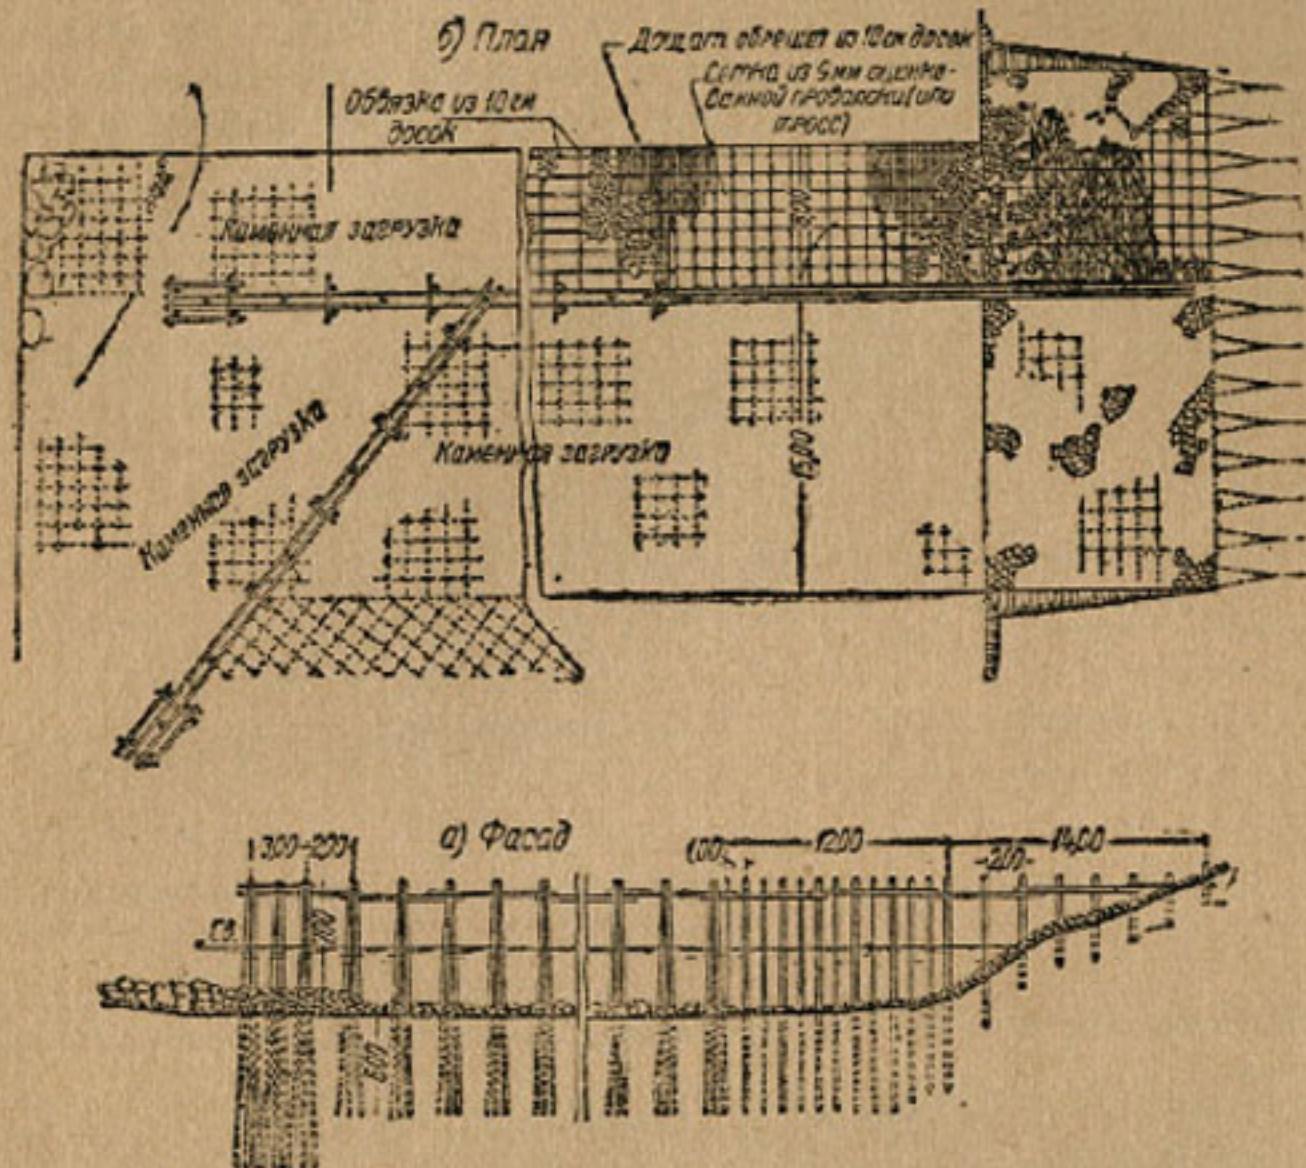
План и фасад свайной эстакады с креплением основания тюфяками.
